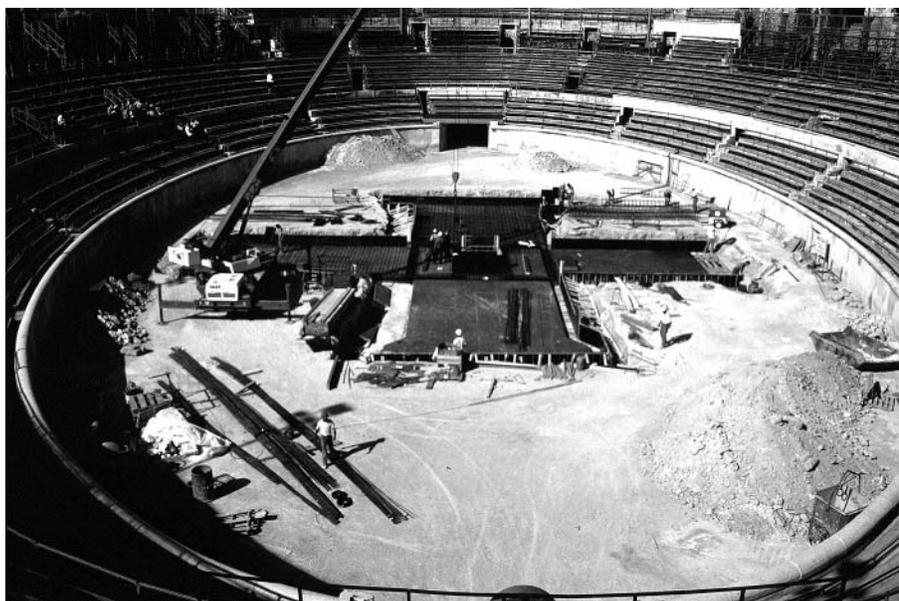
Vue des travaux liés à la mise en place d'un plancher de protection de la partie la mieux conservée du système souterrain de la piste (Cliché M. Célié).
